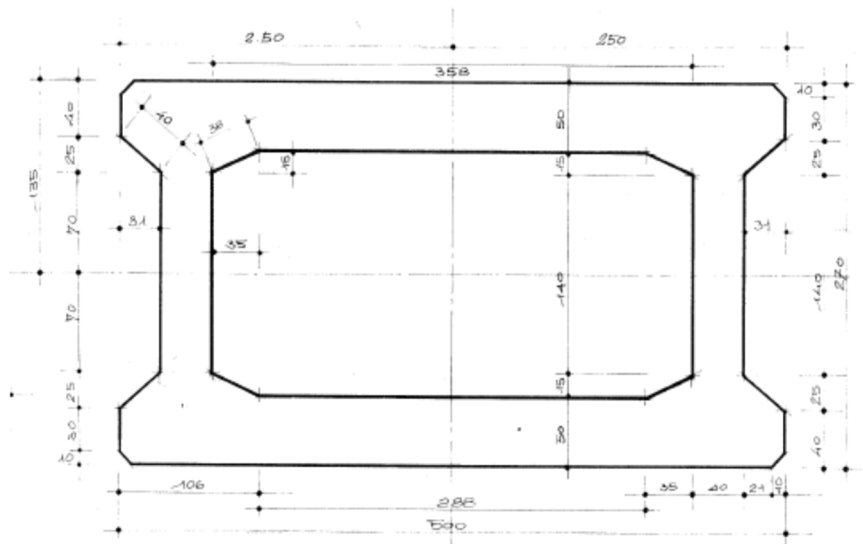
Prospetto Longitudinale e Trasversale pila tipo
